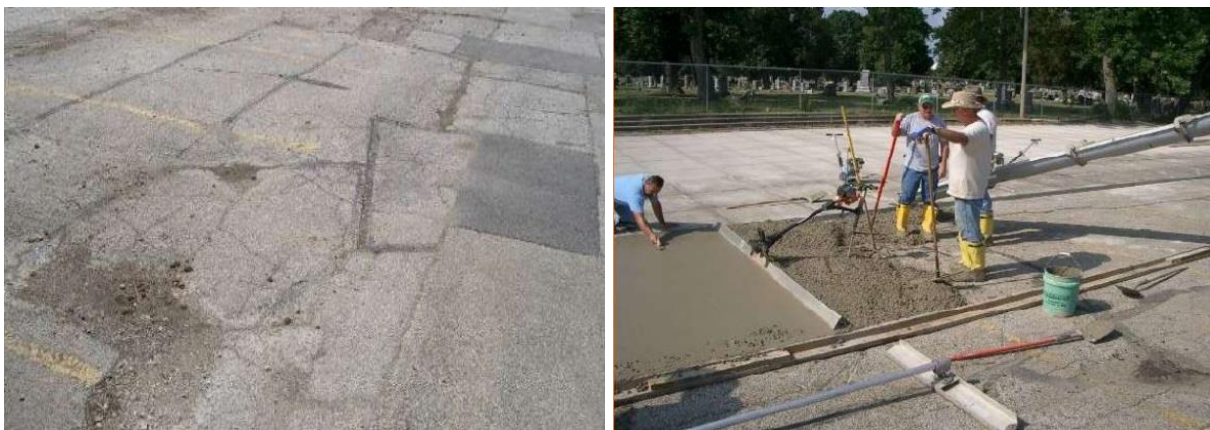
Демонтаж шару підсилення і ремонт покриття швидкотвердіючим бетоном, штат Іллінойс, США
